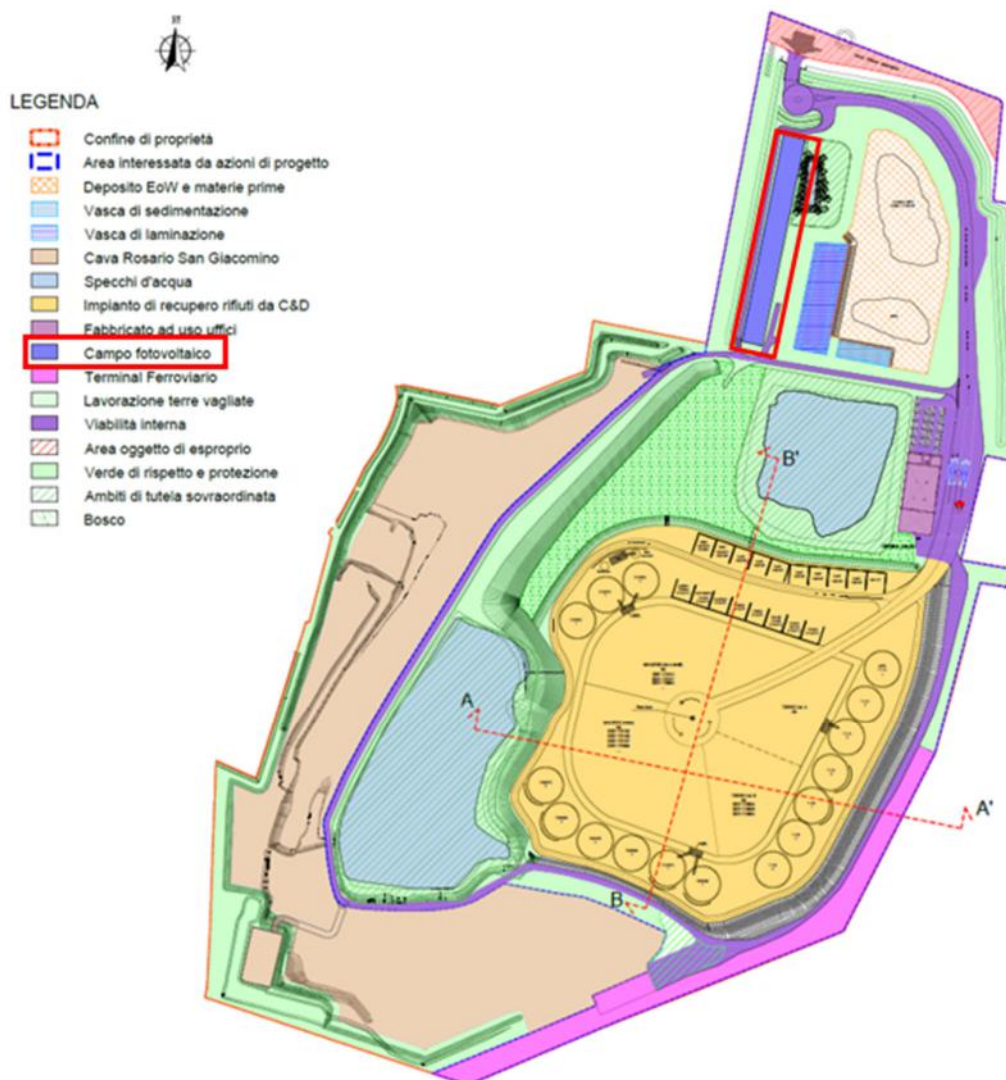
Individuazione zona impianto fotovoltaico (stralcio Tav. PF T11)
